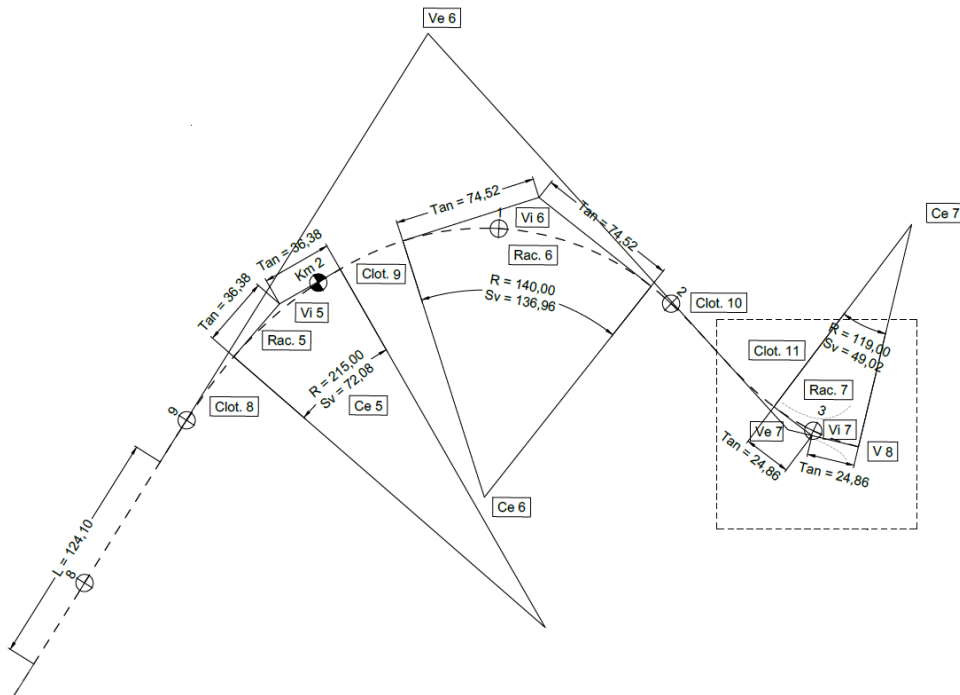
Stralcio del tratto finale della planimetria di tracciamento PD
